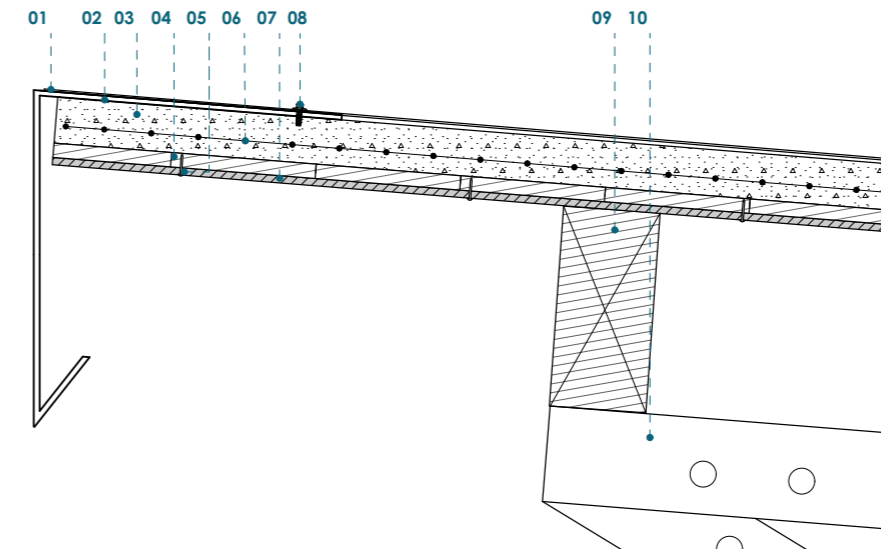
Detalle cubierta. Fuente: Elaboración propia.
